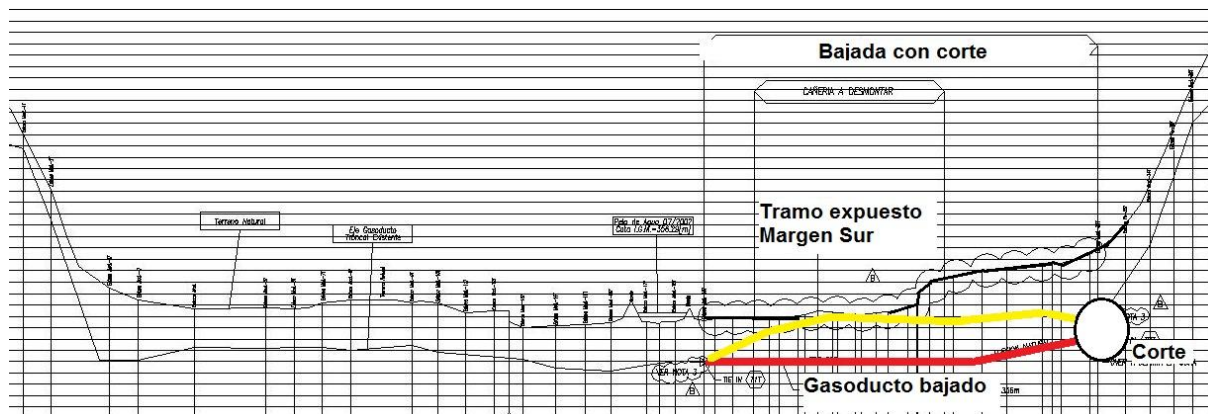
Cruce del Riacho Seco – Obra de bajada de cañería en margen sur
